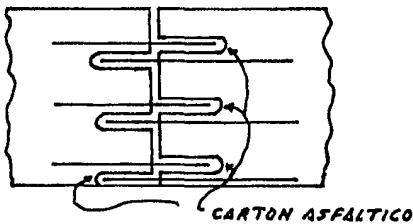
Refuerzo con juntas de expansión
